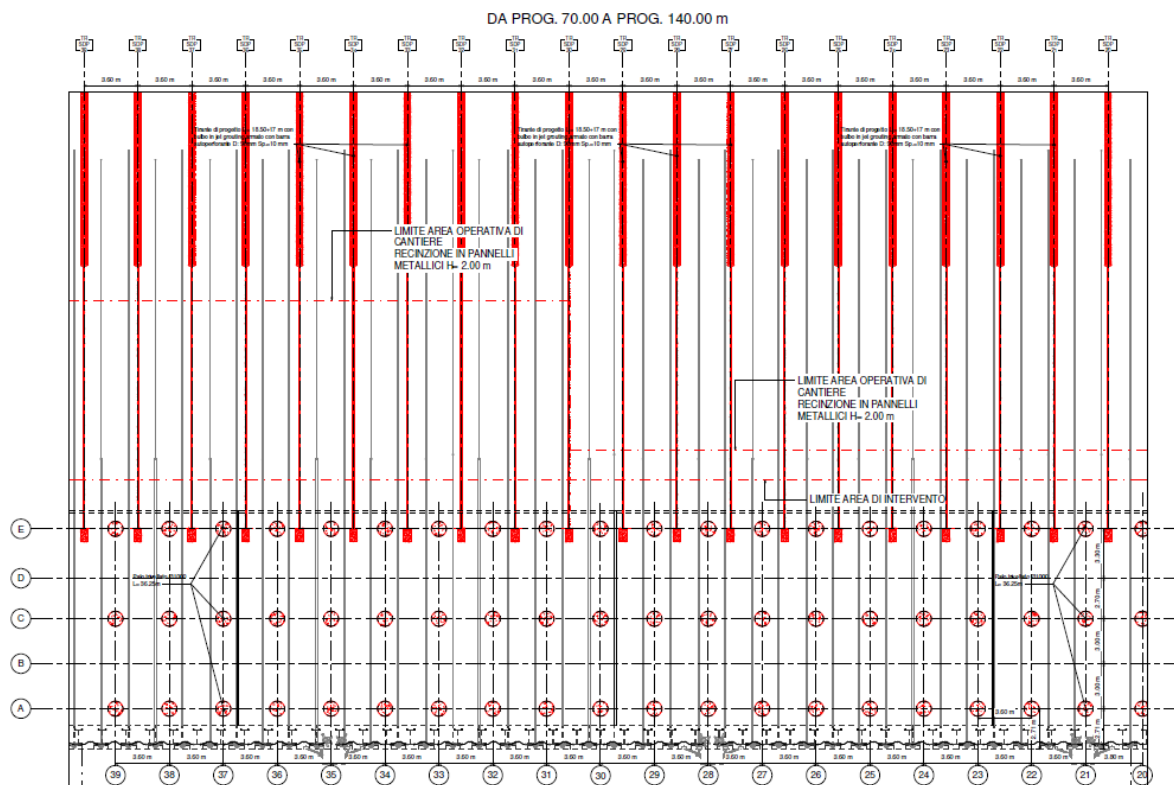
Stralcio planimetrico nuove strutture Trattaroli Sud
